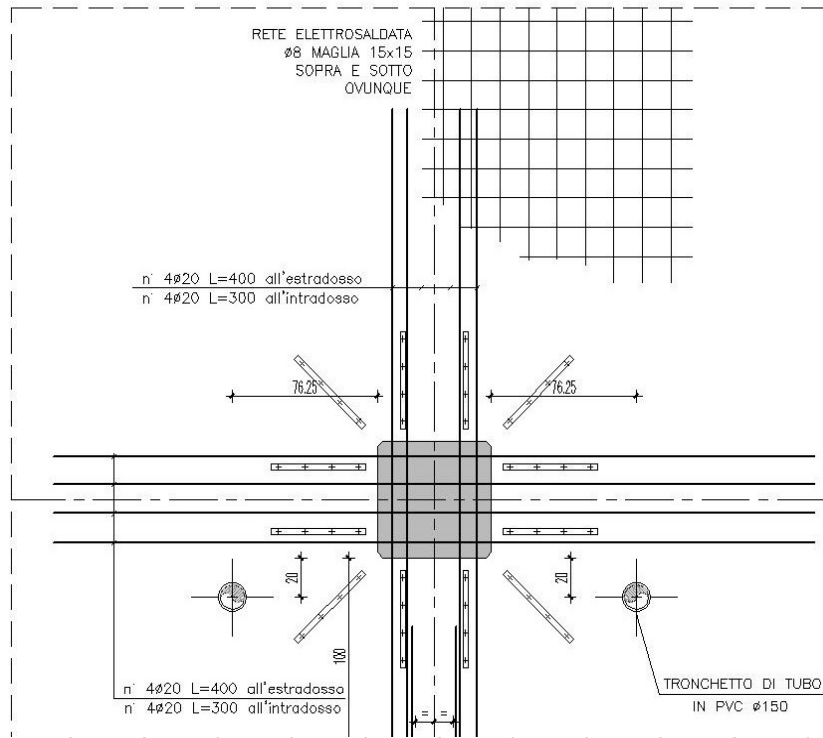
Stralcio pianta di armatura pilastro intermedio del quarto piano
